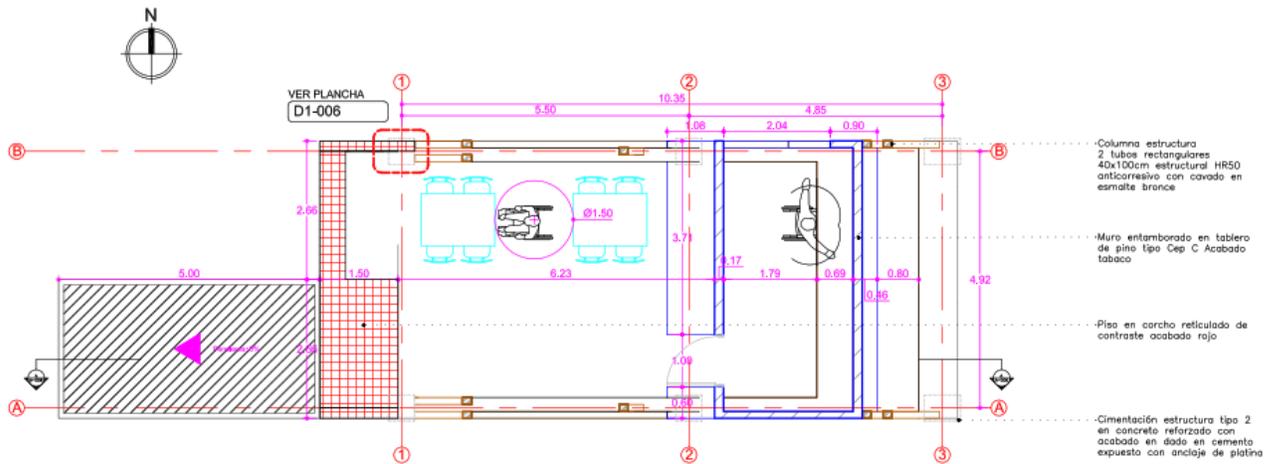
Planta arquitectónica modulo tipo C de U.A.U - 1. Fuente: Elaboración propia.
